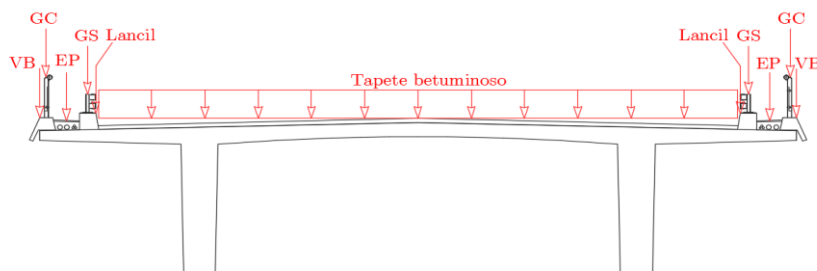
Localização das restantes cargas permanentes na secção transversal corrente do tabuleiro
